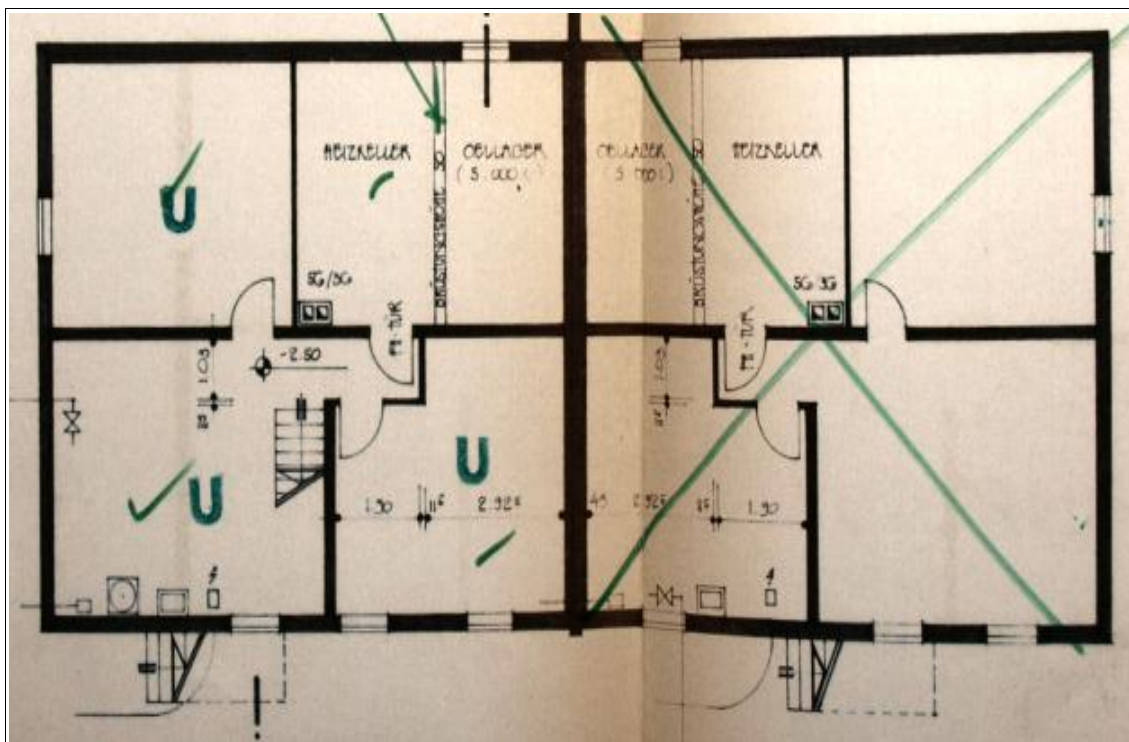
Grundriss Kellergeschoss (DHH Wertermittlungsobjekt links)
